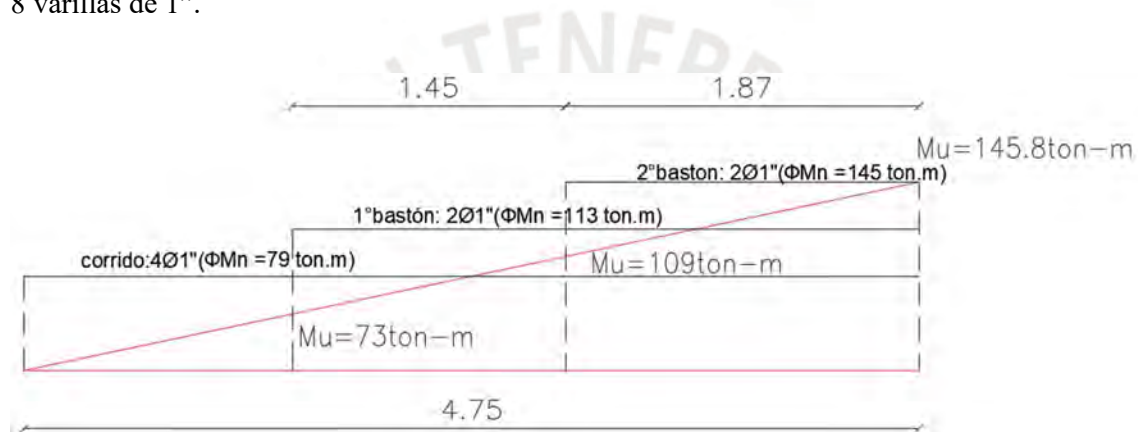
Distribución de acero longitudinal en viga de cimentación
